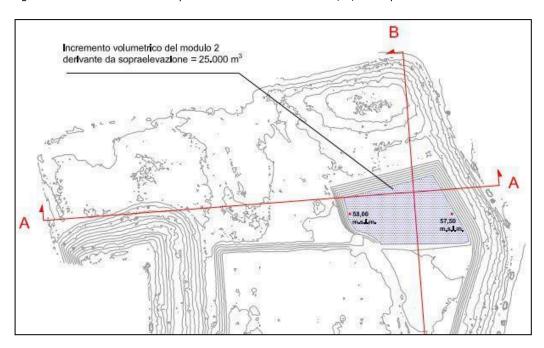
C - Planimetria aree sopraelevazione sul modulo 2 per $25.000 \ m^3$
